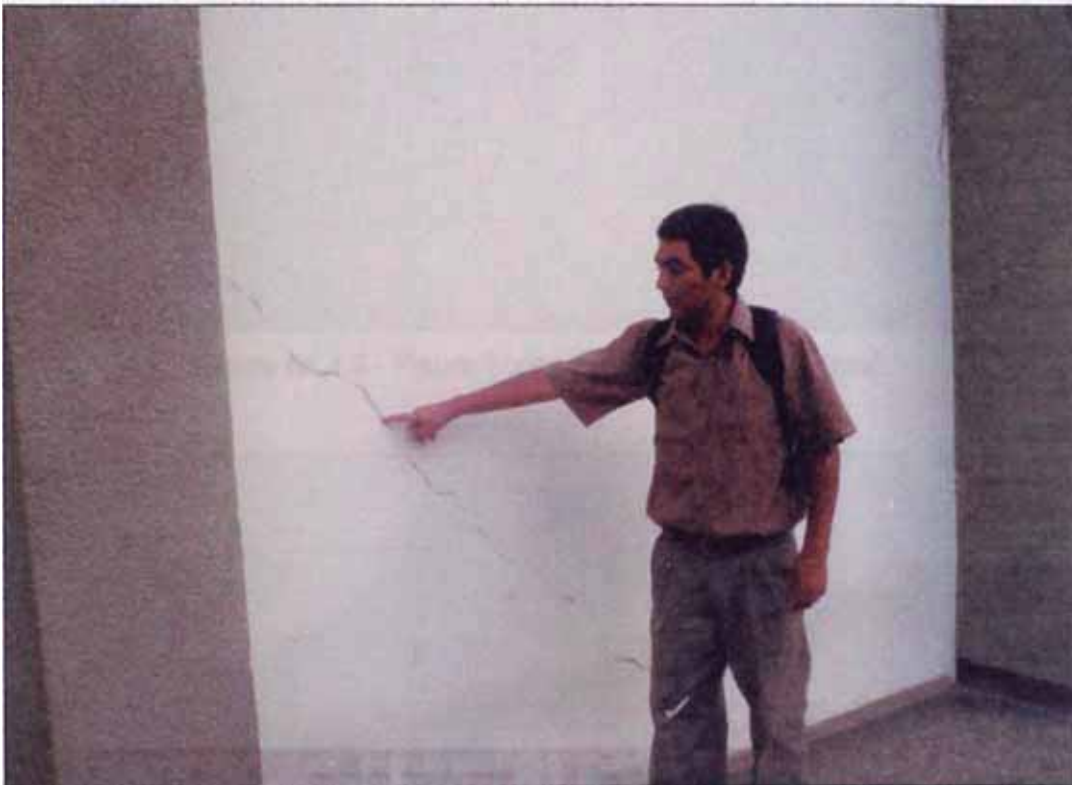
Fisuras diagonales en muros estructurales en el primer nivel.
